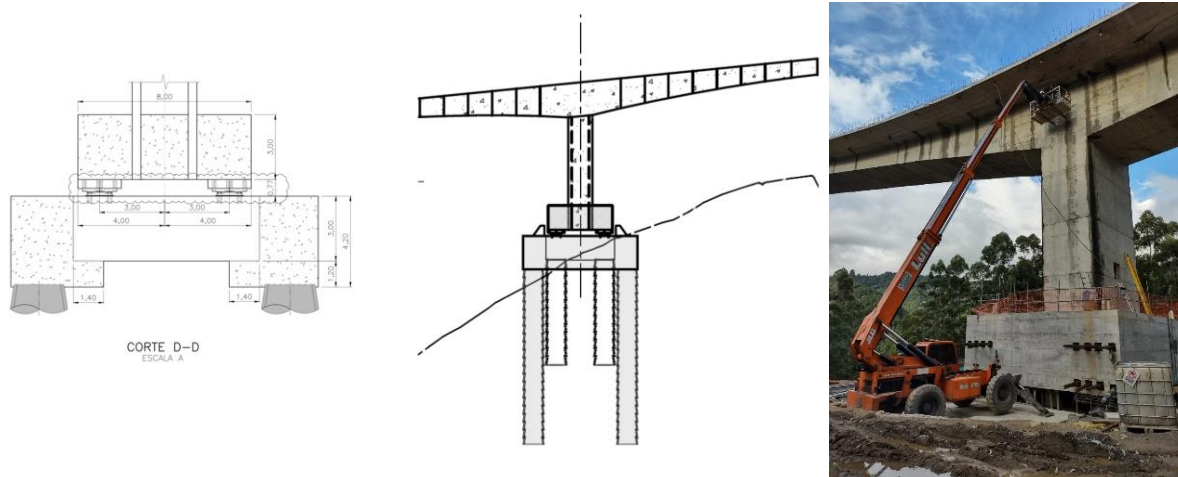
Aislamiento de las pilas cortas. Vista de las pilas
